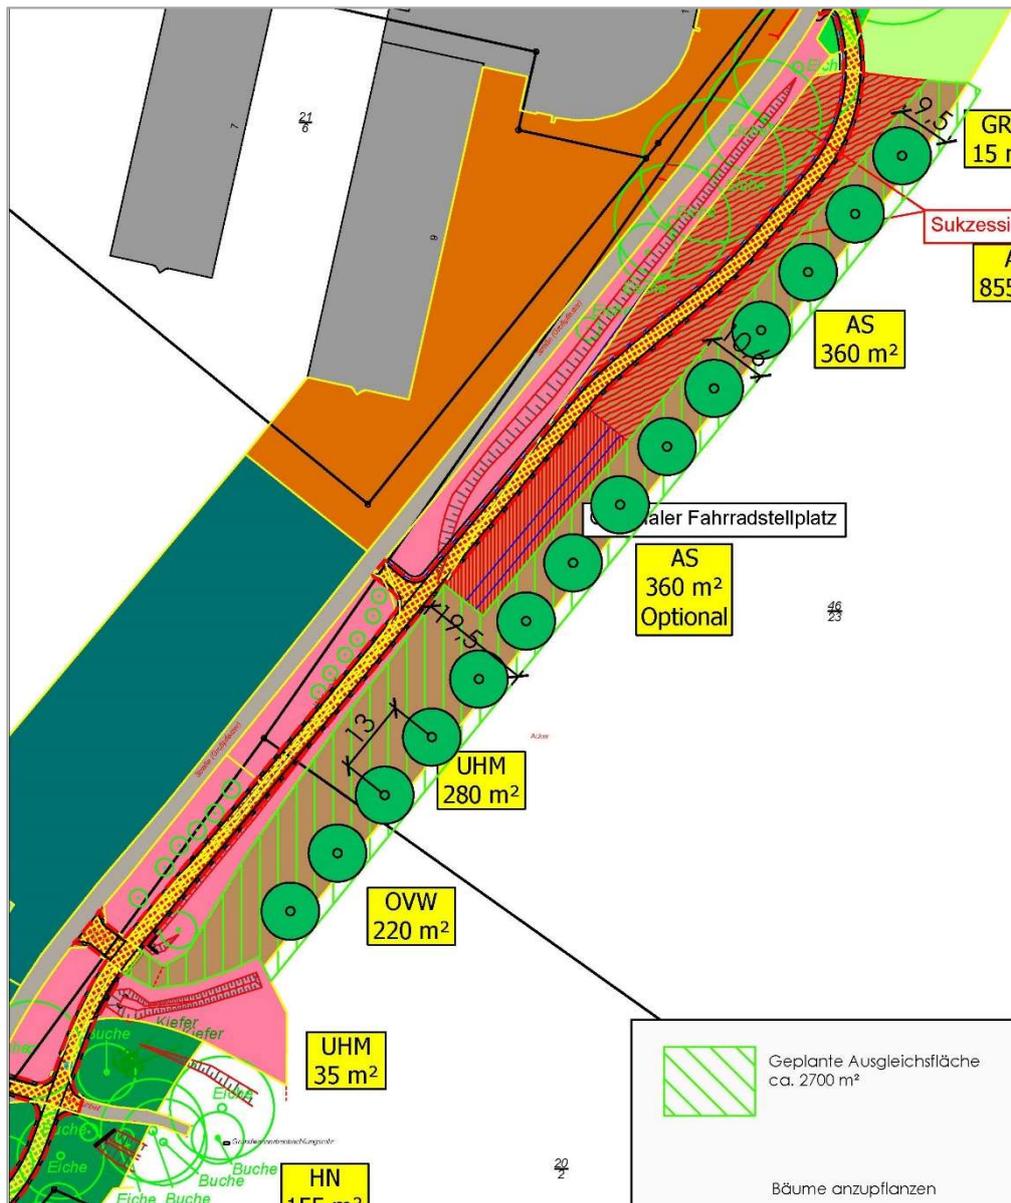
externe Ausgleichsfläche mit Anpflanzung Baumreihe auf Basis Entwurf LBP Radweg Brockwinkler Weg (Gemeinde Reppenstedt)
